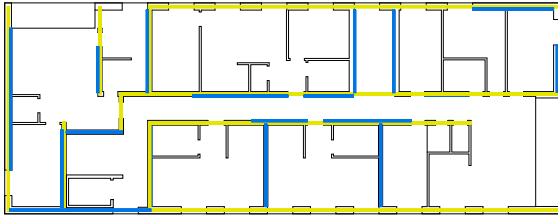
Grundriss mit eingezeichneten Treppenhäusern
